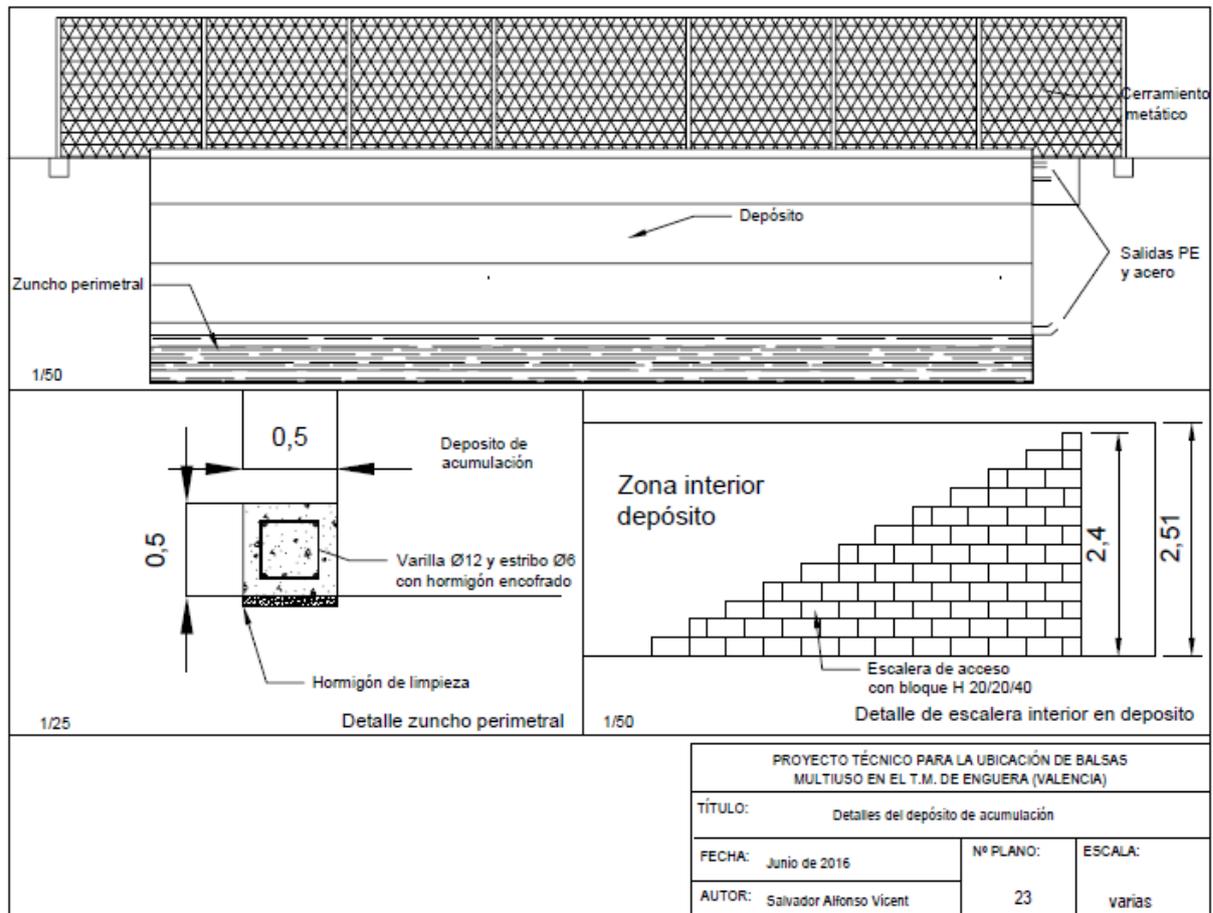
Plano de detalles del depósito de acumulación. Fuente: elaboración propia con Autocad
